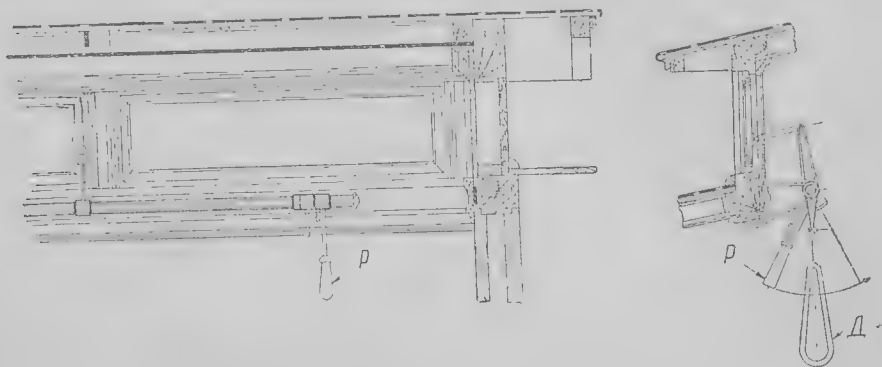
Световой фонарь: *P* — ручка механизма для открытия форточек, *Д* — держатель ременный.
